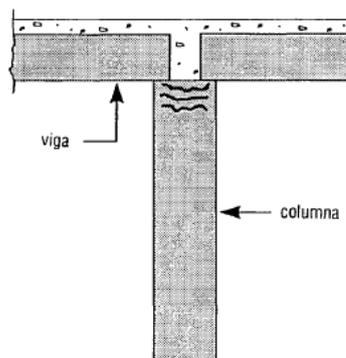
FISURAS DE ASENTAMIENTO PLÁSTICO
